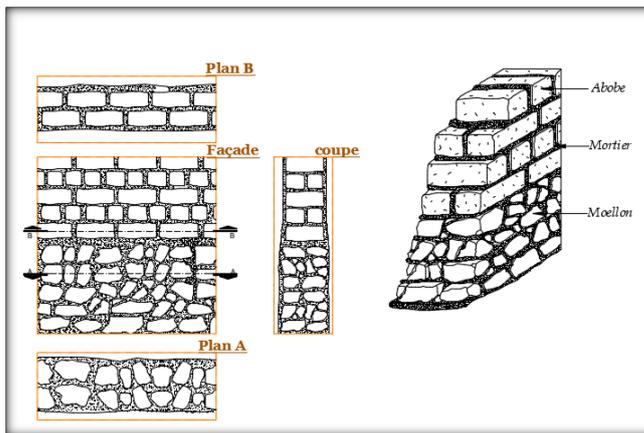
Détails constructifs d'un mur porteur en brique de terre crue. Source : auteur
